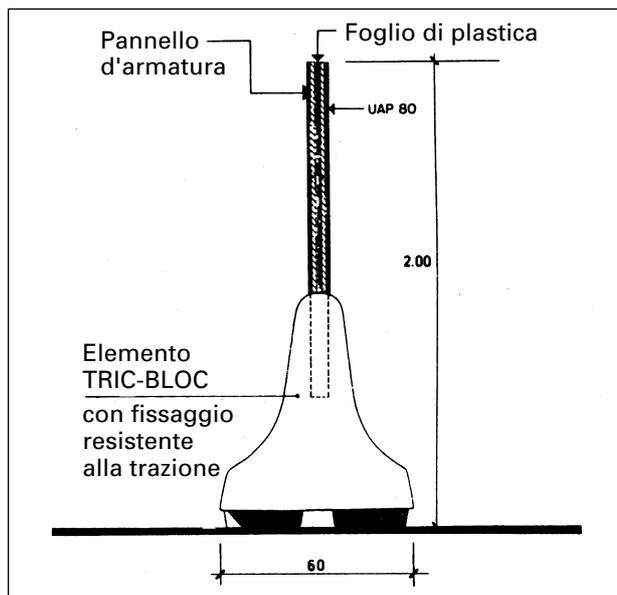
elemento Tric-Bloc sormontato da una parete di protezione
